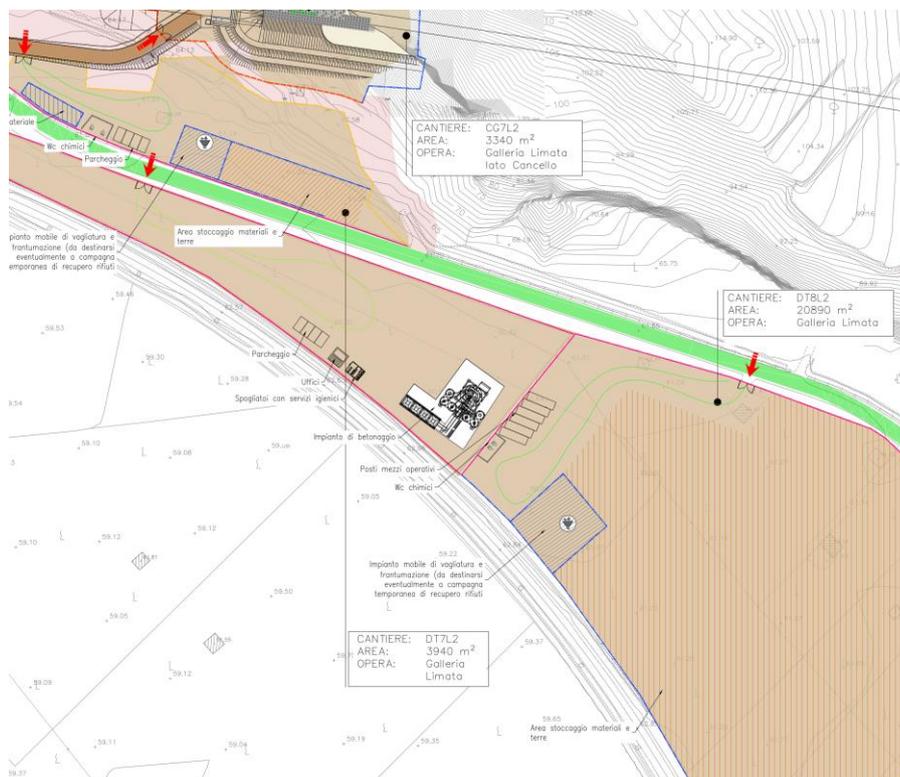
Planimetria di dettaglio DT7L2 e DT8L2
